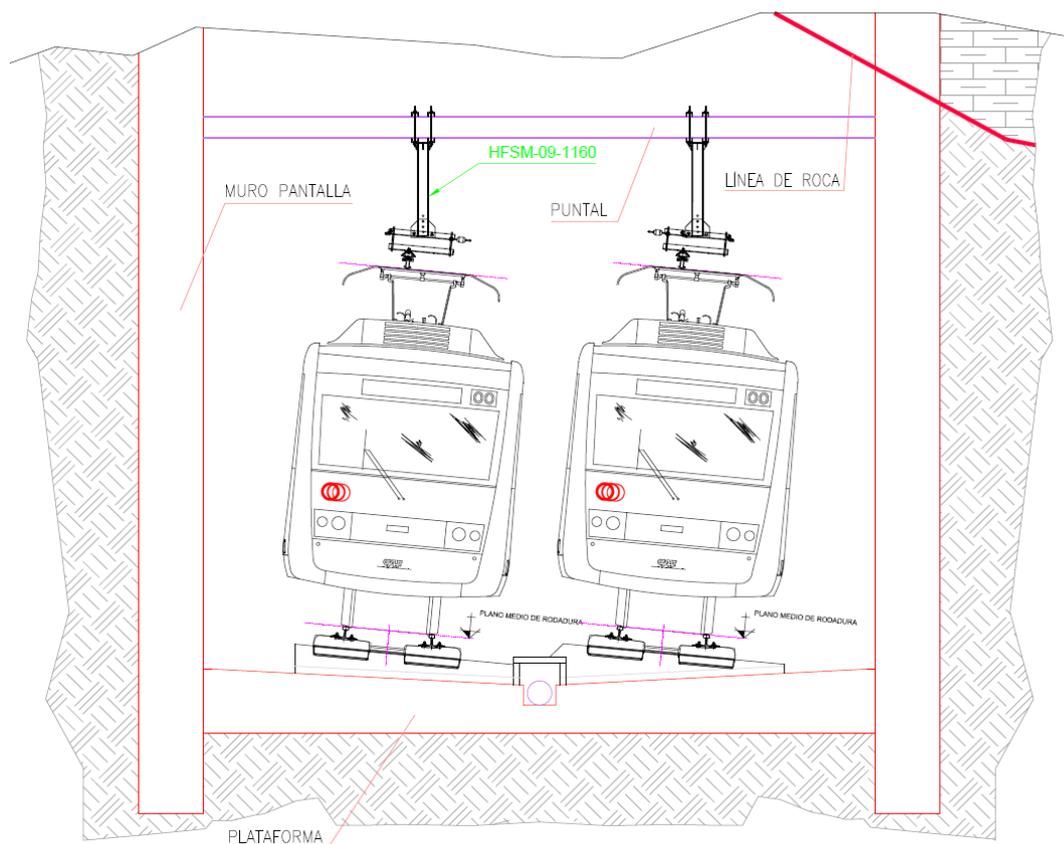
Ejemplo sección tipo con viga soporte (fuente: as-built obra electrificación tramo Loiola – Herrera)
